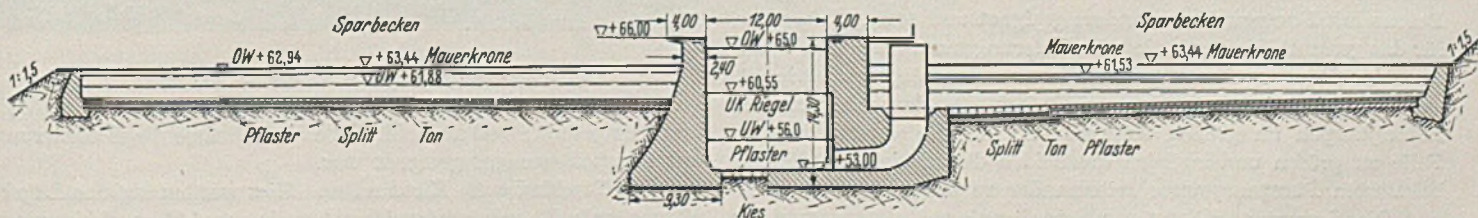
Querschnitt einer Schleusenammer mit Sparbecken.
